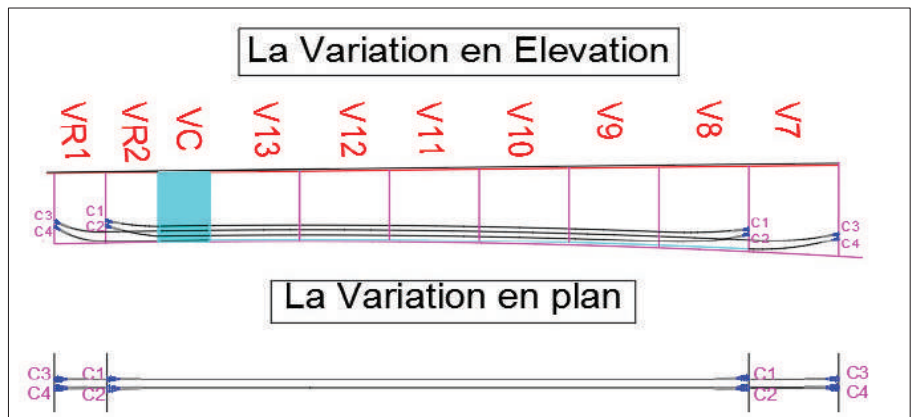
Tracé des câbles en élévation et en plan « T-RIVE »
